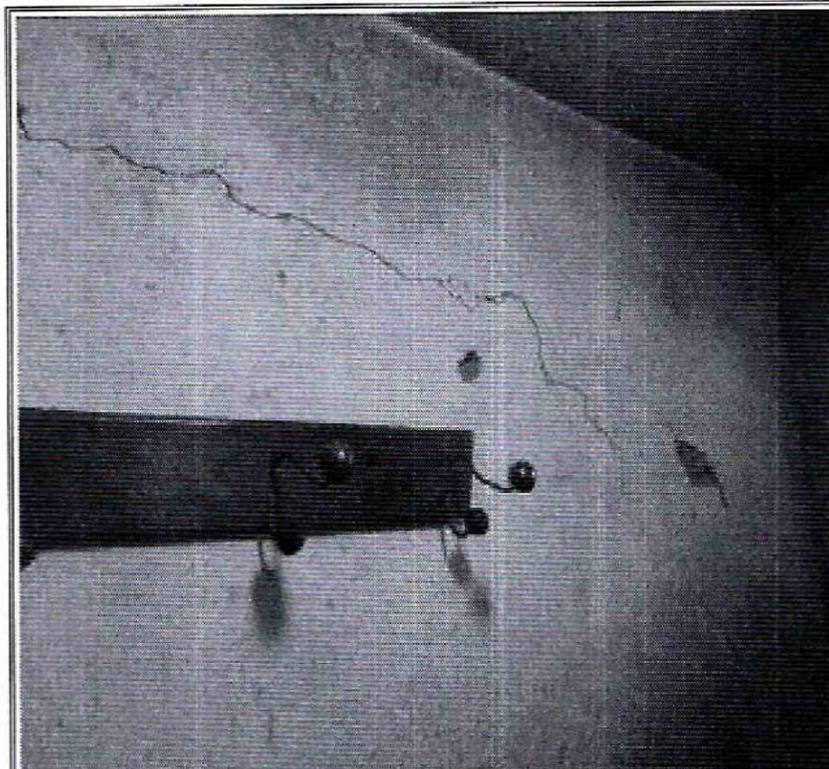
Grietas tendencia horizontal muro de cerramiento perimetral costado suroccidental predio de la Calle 89 Bis Sur No. 8 D - 09 Este
